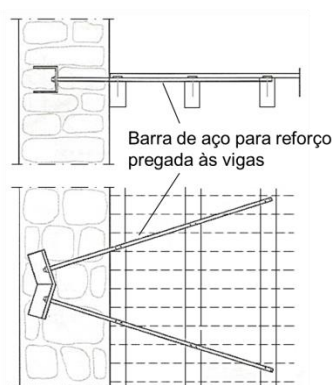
Representação esquemática do reforço de ligação entre o pavimento de madeira e as paredes transversais (adaptado de Baião, et al., 2012)
